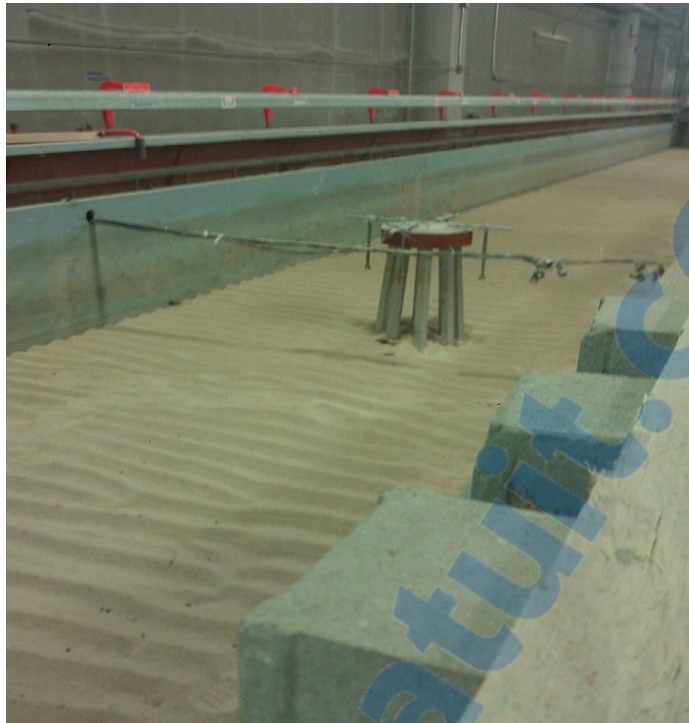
Le laboratoire de CSU : Un essai sur un groupe de piles (ensemble de pieux au dessous d'une semelle)
